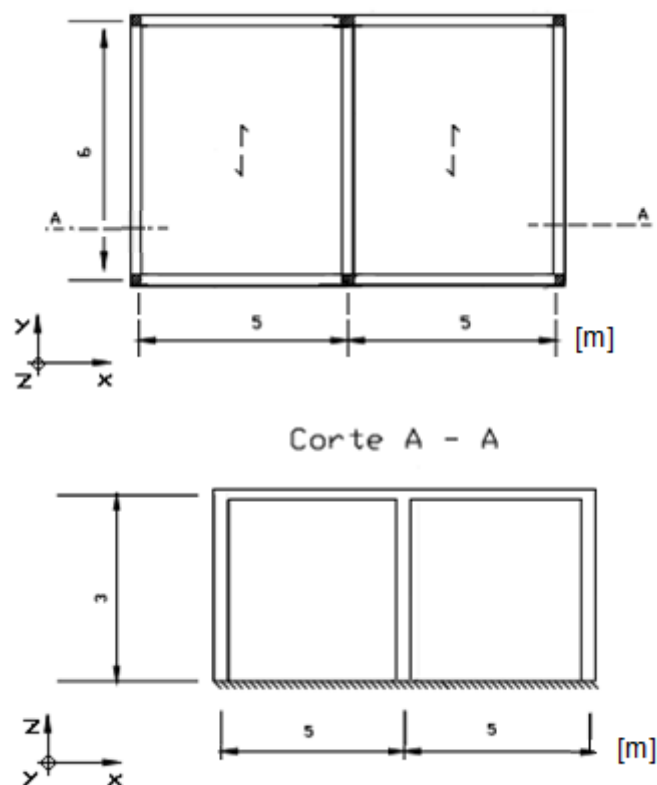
Planta e Corte A-A (Dimensões Consideradas)
